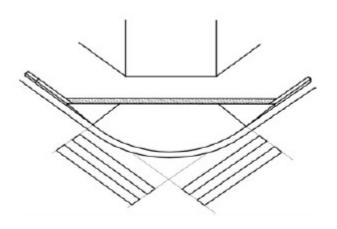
Rebaixo de passeio, para travessia de pedestres localizado na esquina
